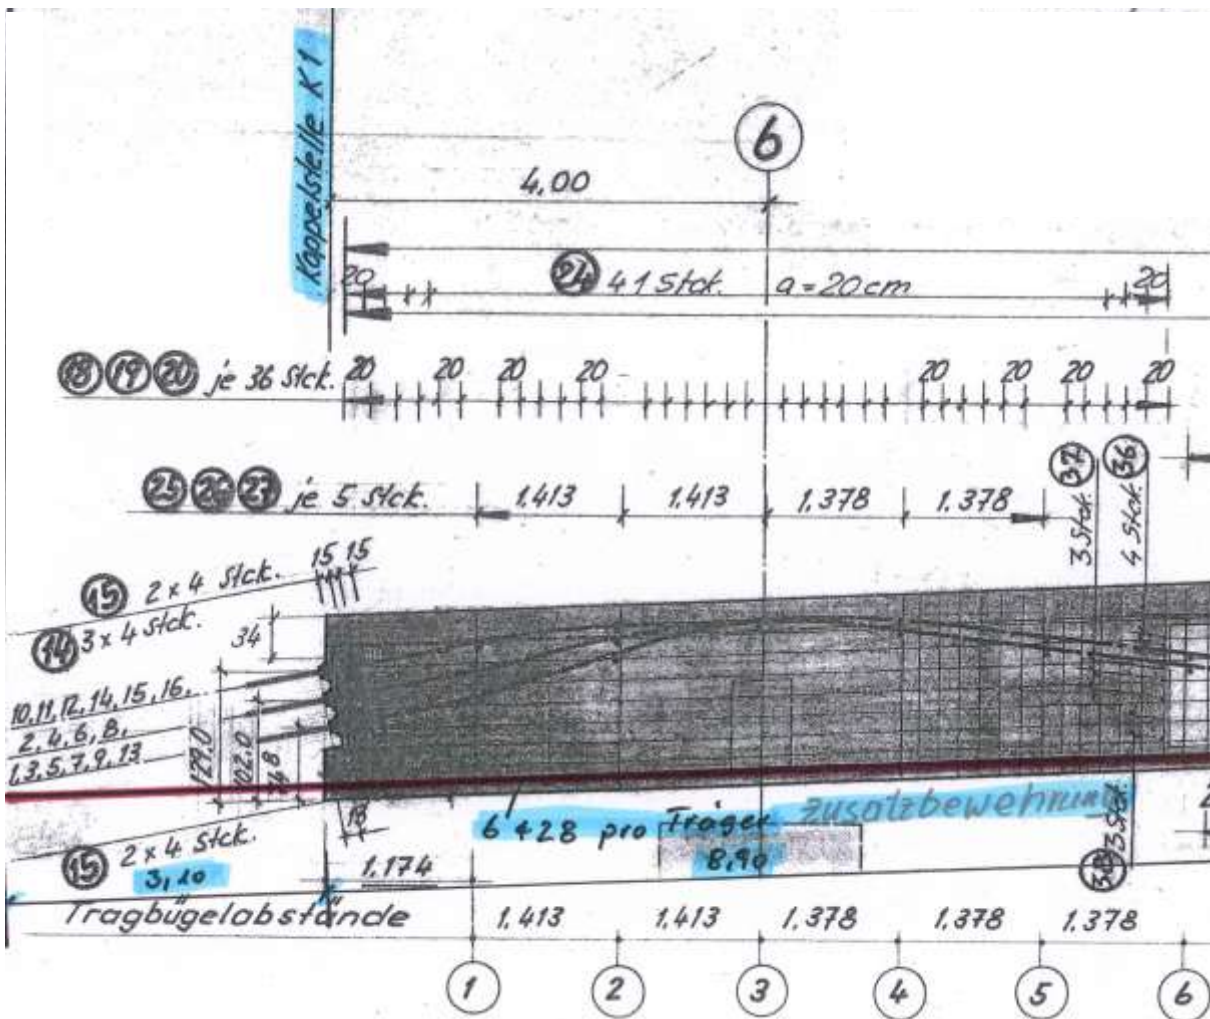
Längsschnitt der Koppelstelle mit Zusatzbewehrung
